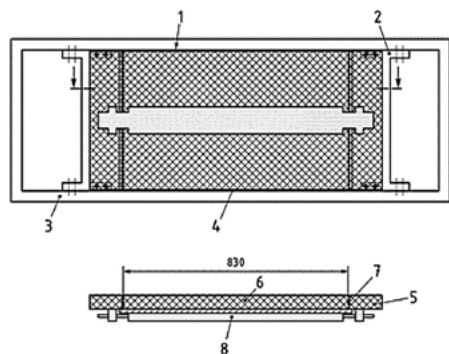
Prüfvorrichtung nach DIN 18104 Teil 1 für aufschraubbare Nachrüstprodukte. Das Bild zeigt den Prüfaufbau für einen Querriegel.
